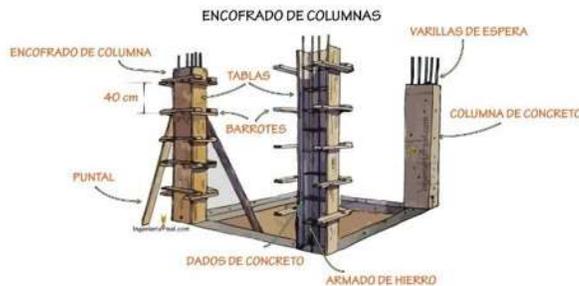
Columnas de concreto armado. Fuente: <https://ingenieriareal.com/desencofrado-losas-columnas/>. [16/10/20].
